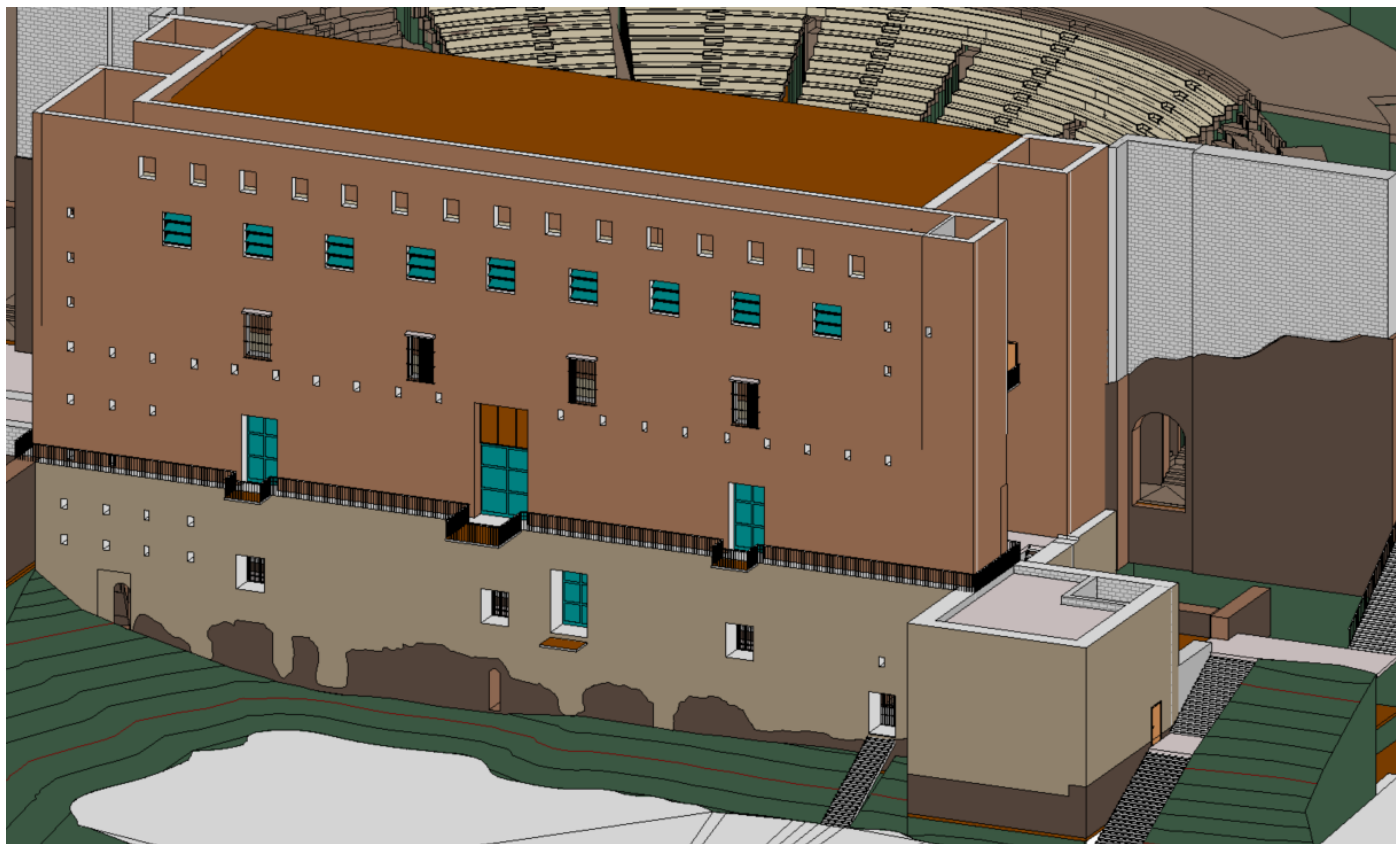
Solapamiento de los muros romanos con los muros propuestos en la intervención.
